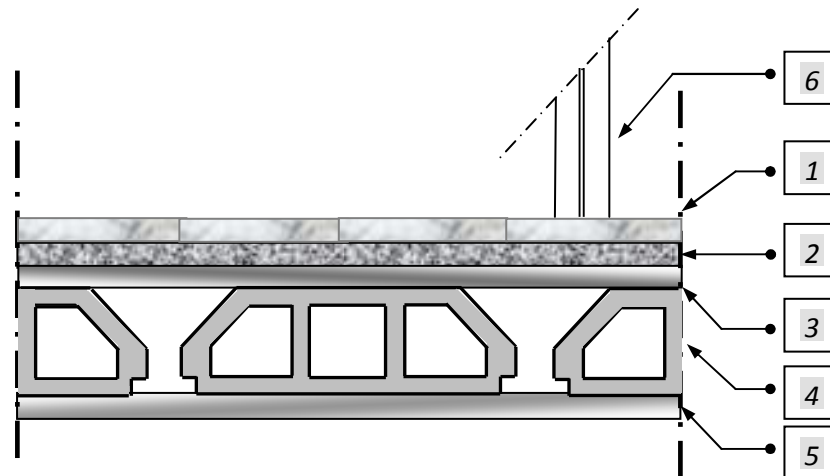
Coupe verticale du plancher terrasse à corps creux
